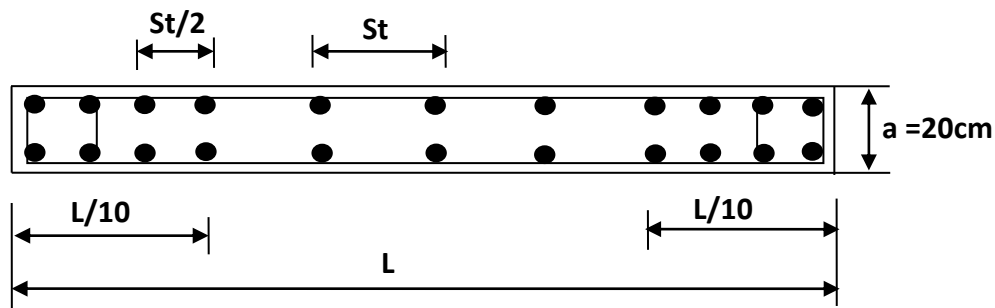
Disposition des armatures verticales dans les voiles.
